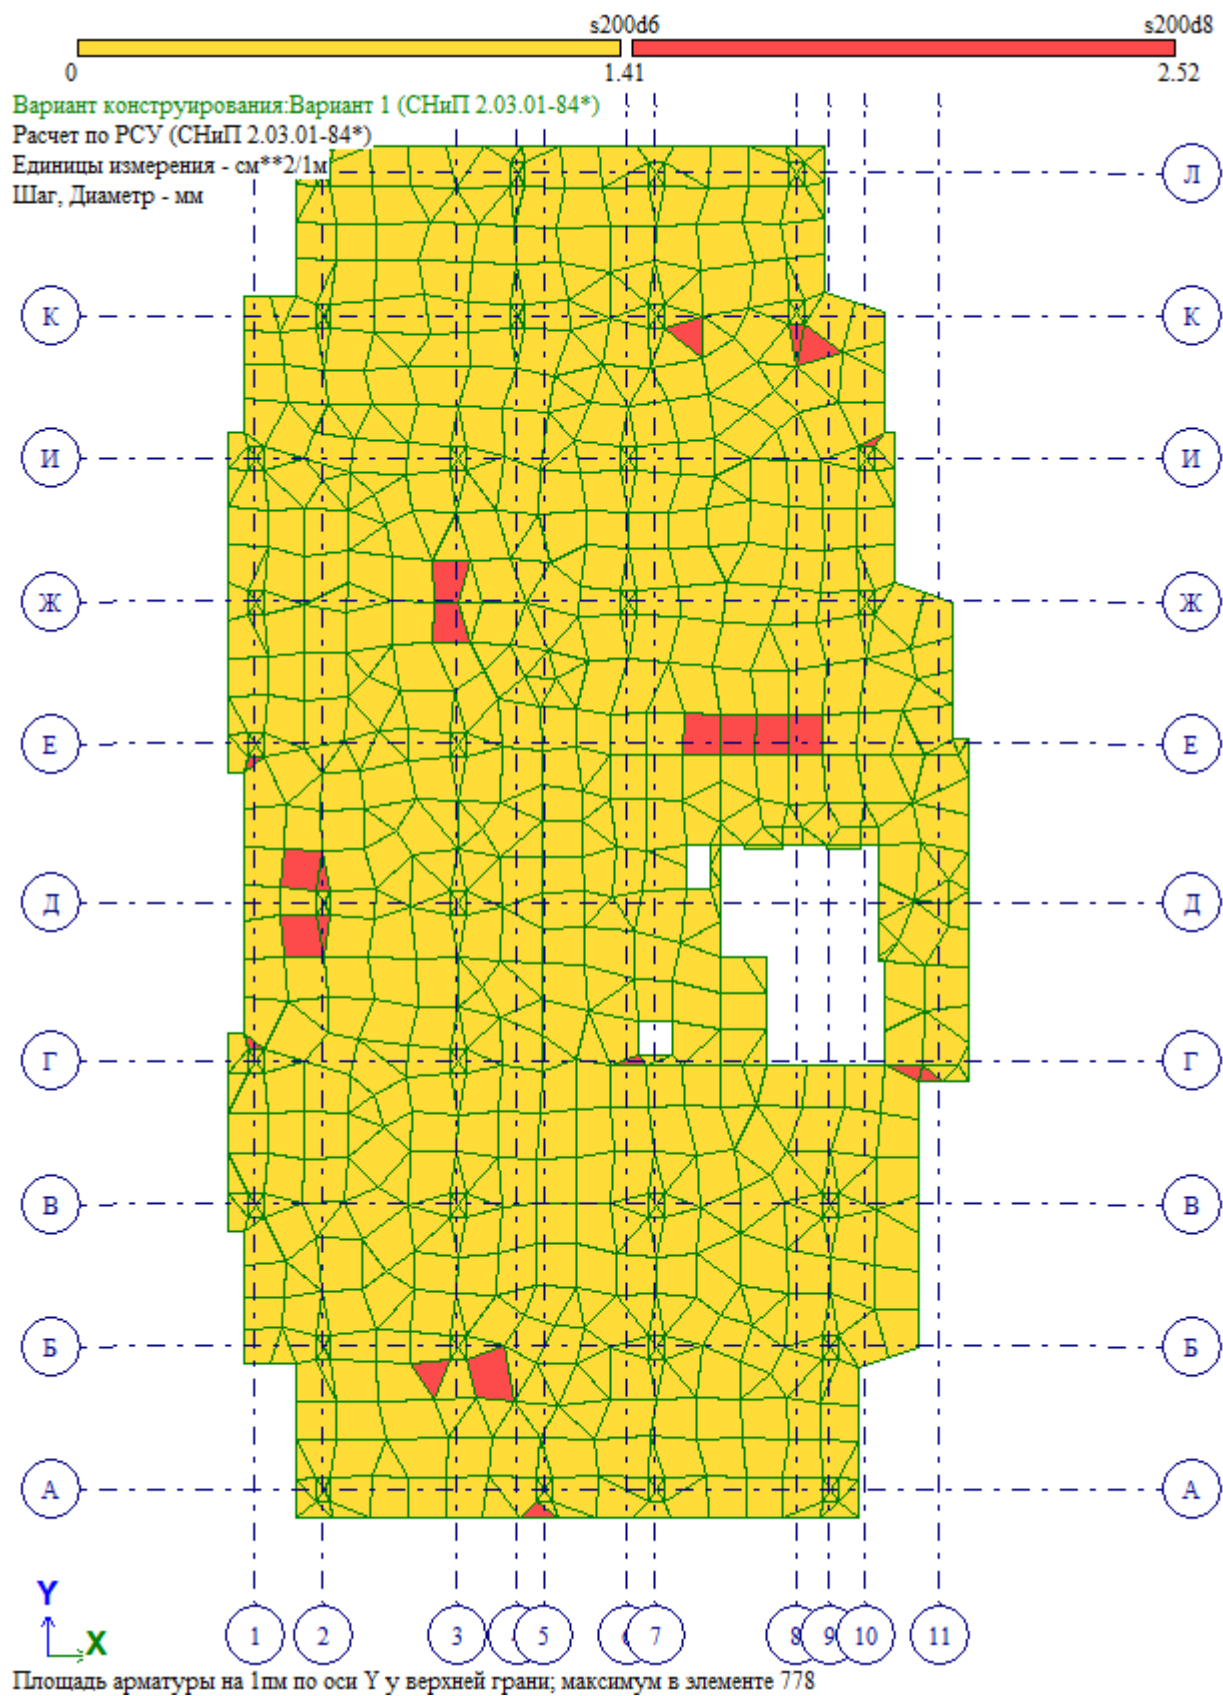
Площадь верхней арматуры вдоль цифровых осей.
